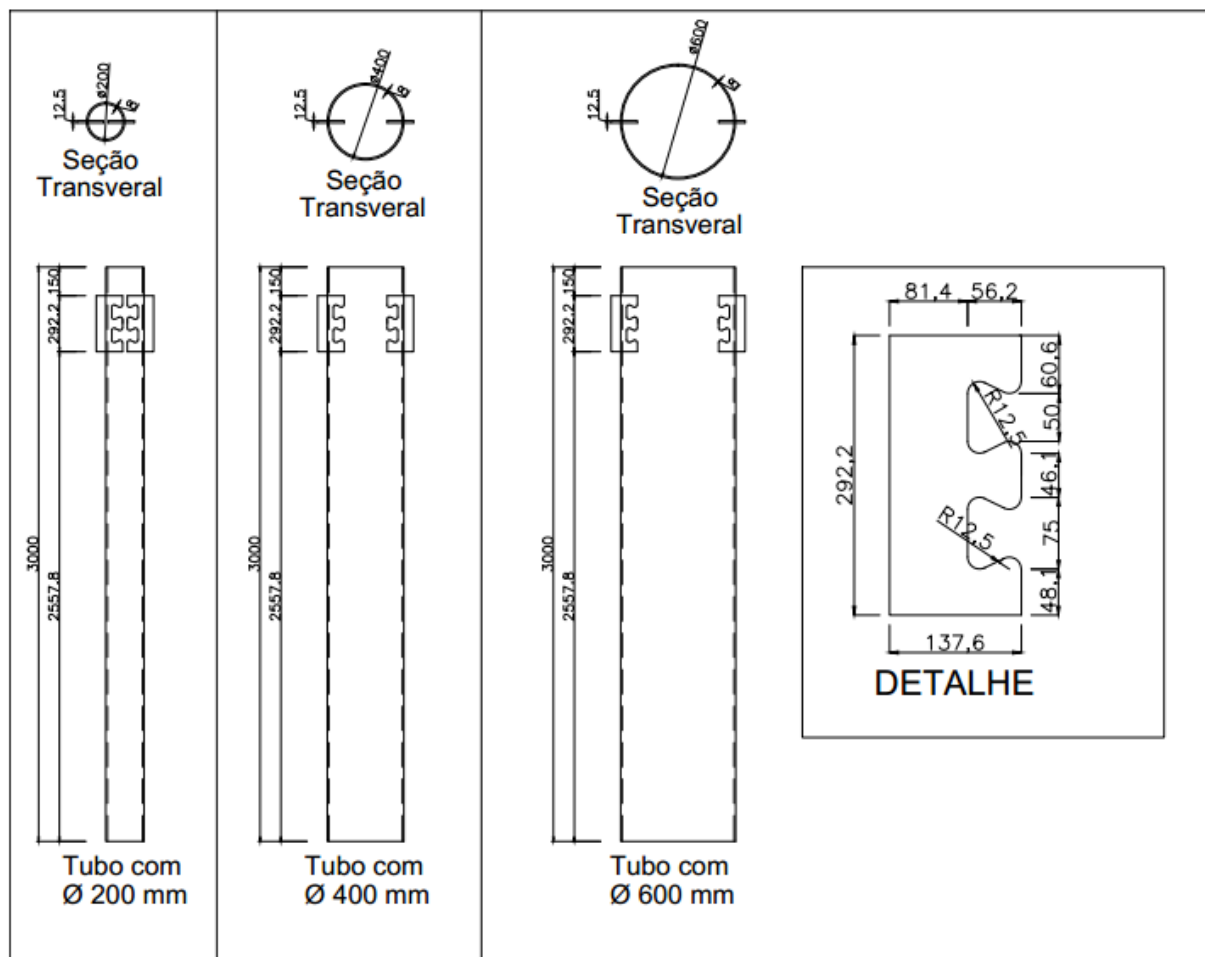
Detalhamento dos Pilares com o Crestbond
